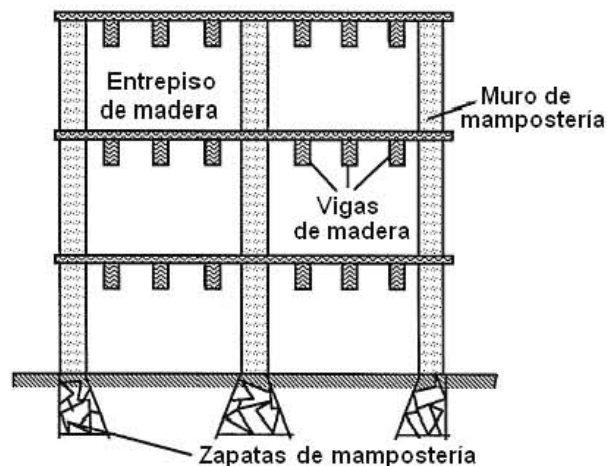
Muros de carga de mampostería sin reforzar (Aguilar et al., 1996)
